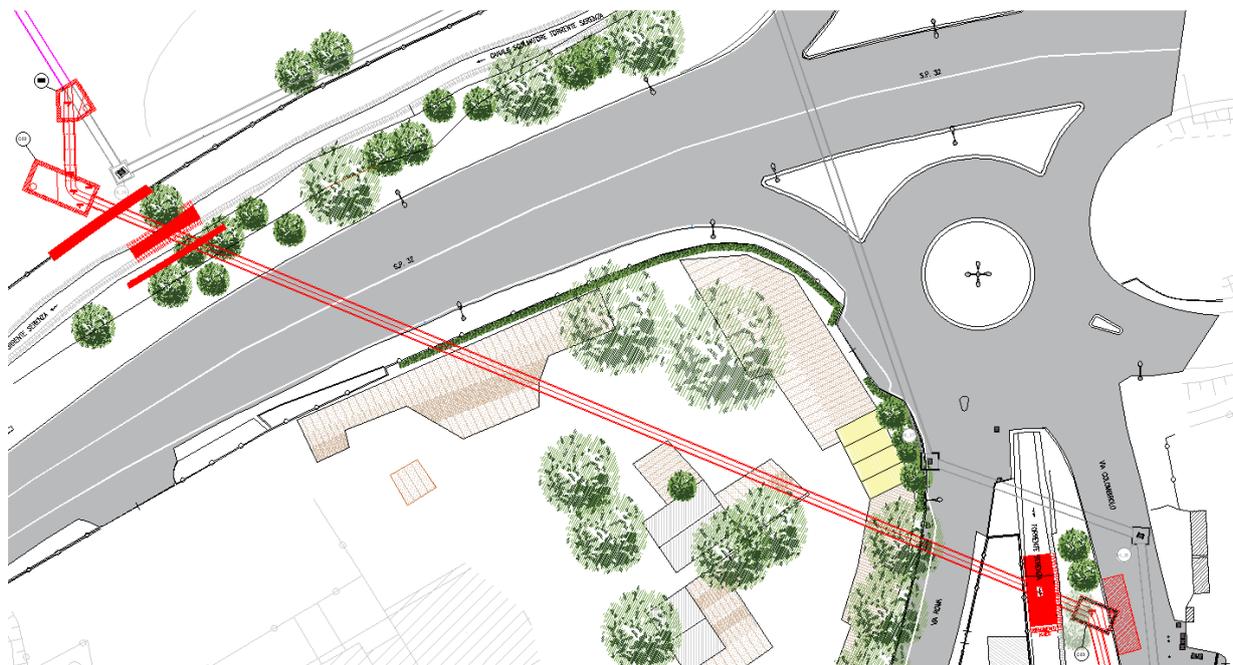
Planimetria di progetto con tracciato del collettore nel tratto in spingitubo
